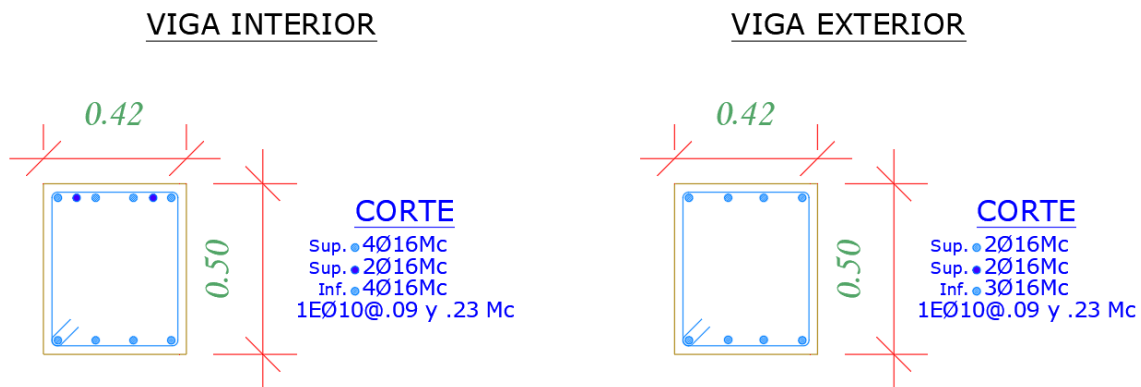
Secciones transversales de las vigas utilizadas en un edificio de 2 pisos para $\Delta_M = 0.5\%$.
